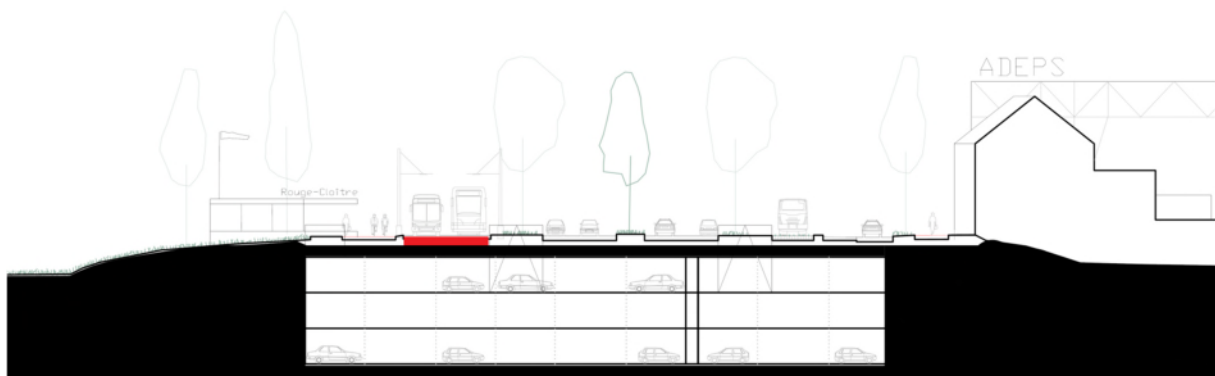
Coupe à travers le P+R sur le site Stade-Adeps (ORG², 2018)
